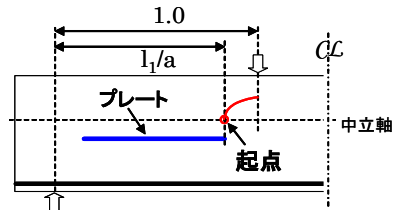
プレート埋込み型部材での斜めひび割れの起点の設定
